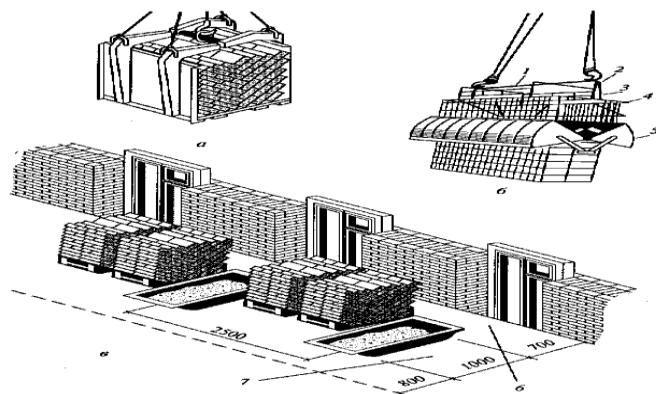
Подъем кирпича с использованием: а — захвата-футляра; б — зажимного захвата; 1 — труба-распорка; 2 — серьга; 3 — тяга; 4 — рама каркаса; 5 — челюсть; в — установка на рабочем месте; 6 — рабочая зона; 7 — зона расположения материалов.
